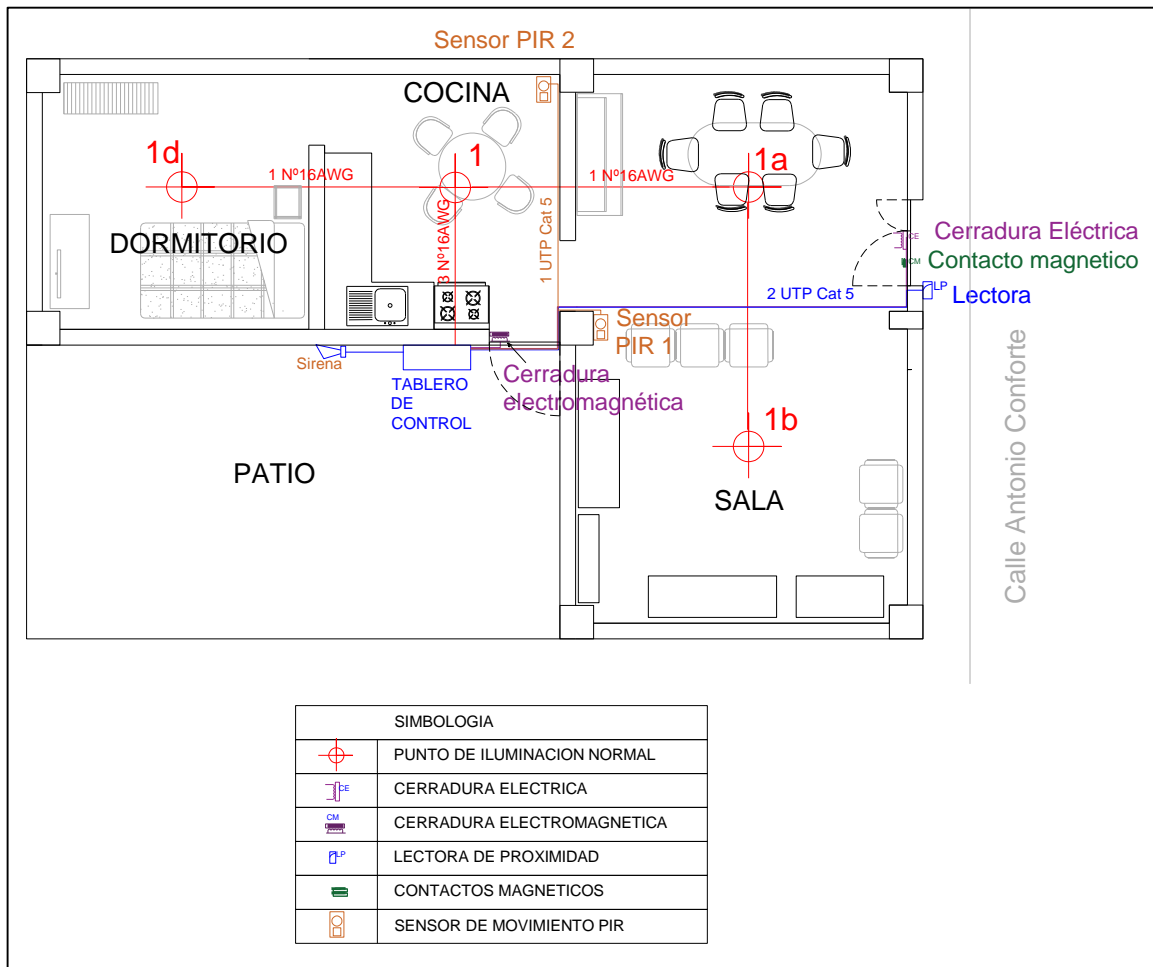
Plano ubicación de elementos. Fuente: Elaborado por el autor
